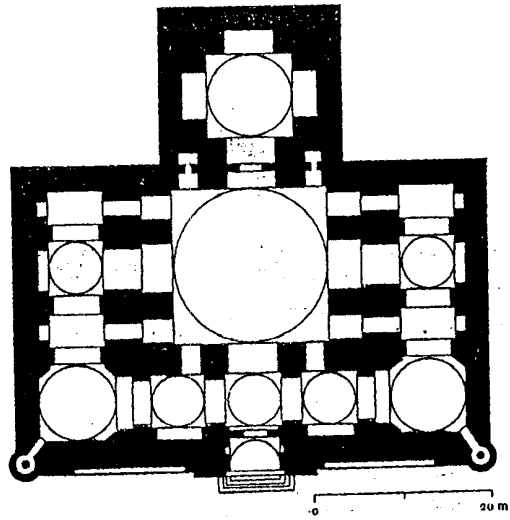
مسقط أفقي لجامع اسحاق باشا في اينه كول (عن Kuran)
